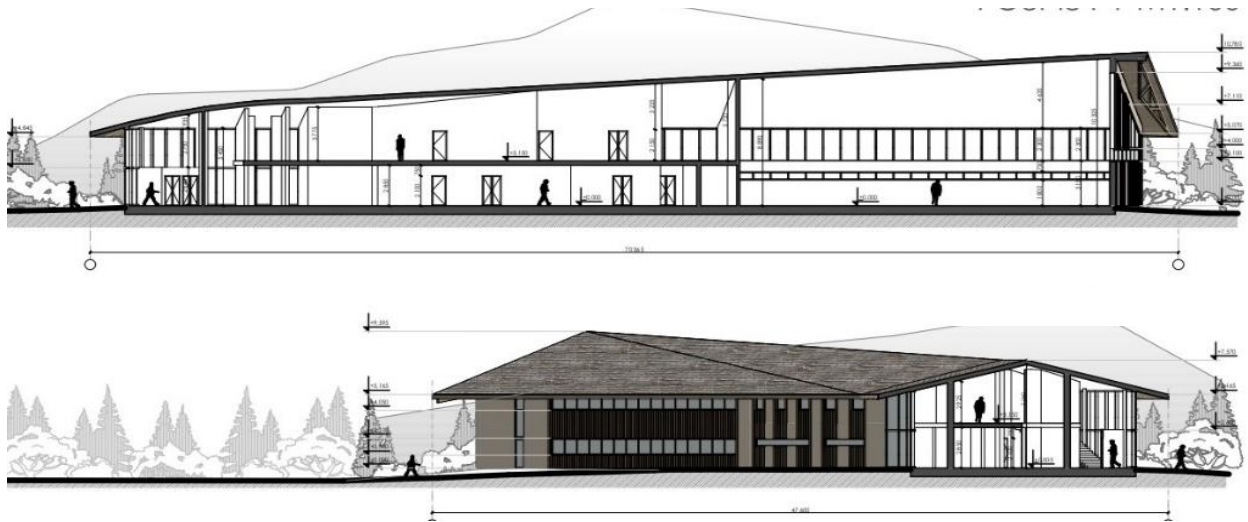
Розрізи спортивно-оздоровчого корпусу
